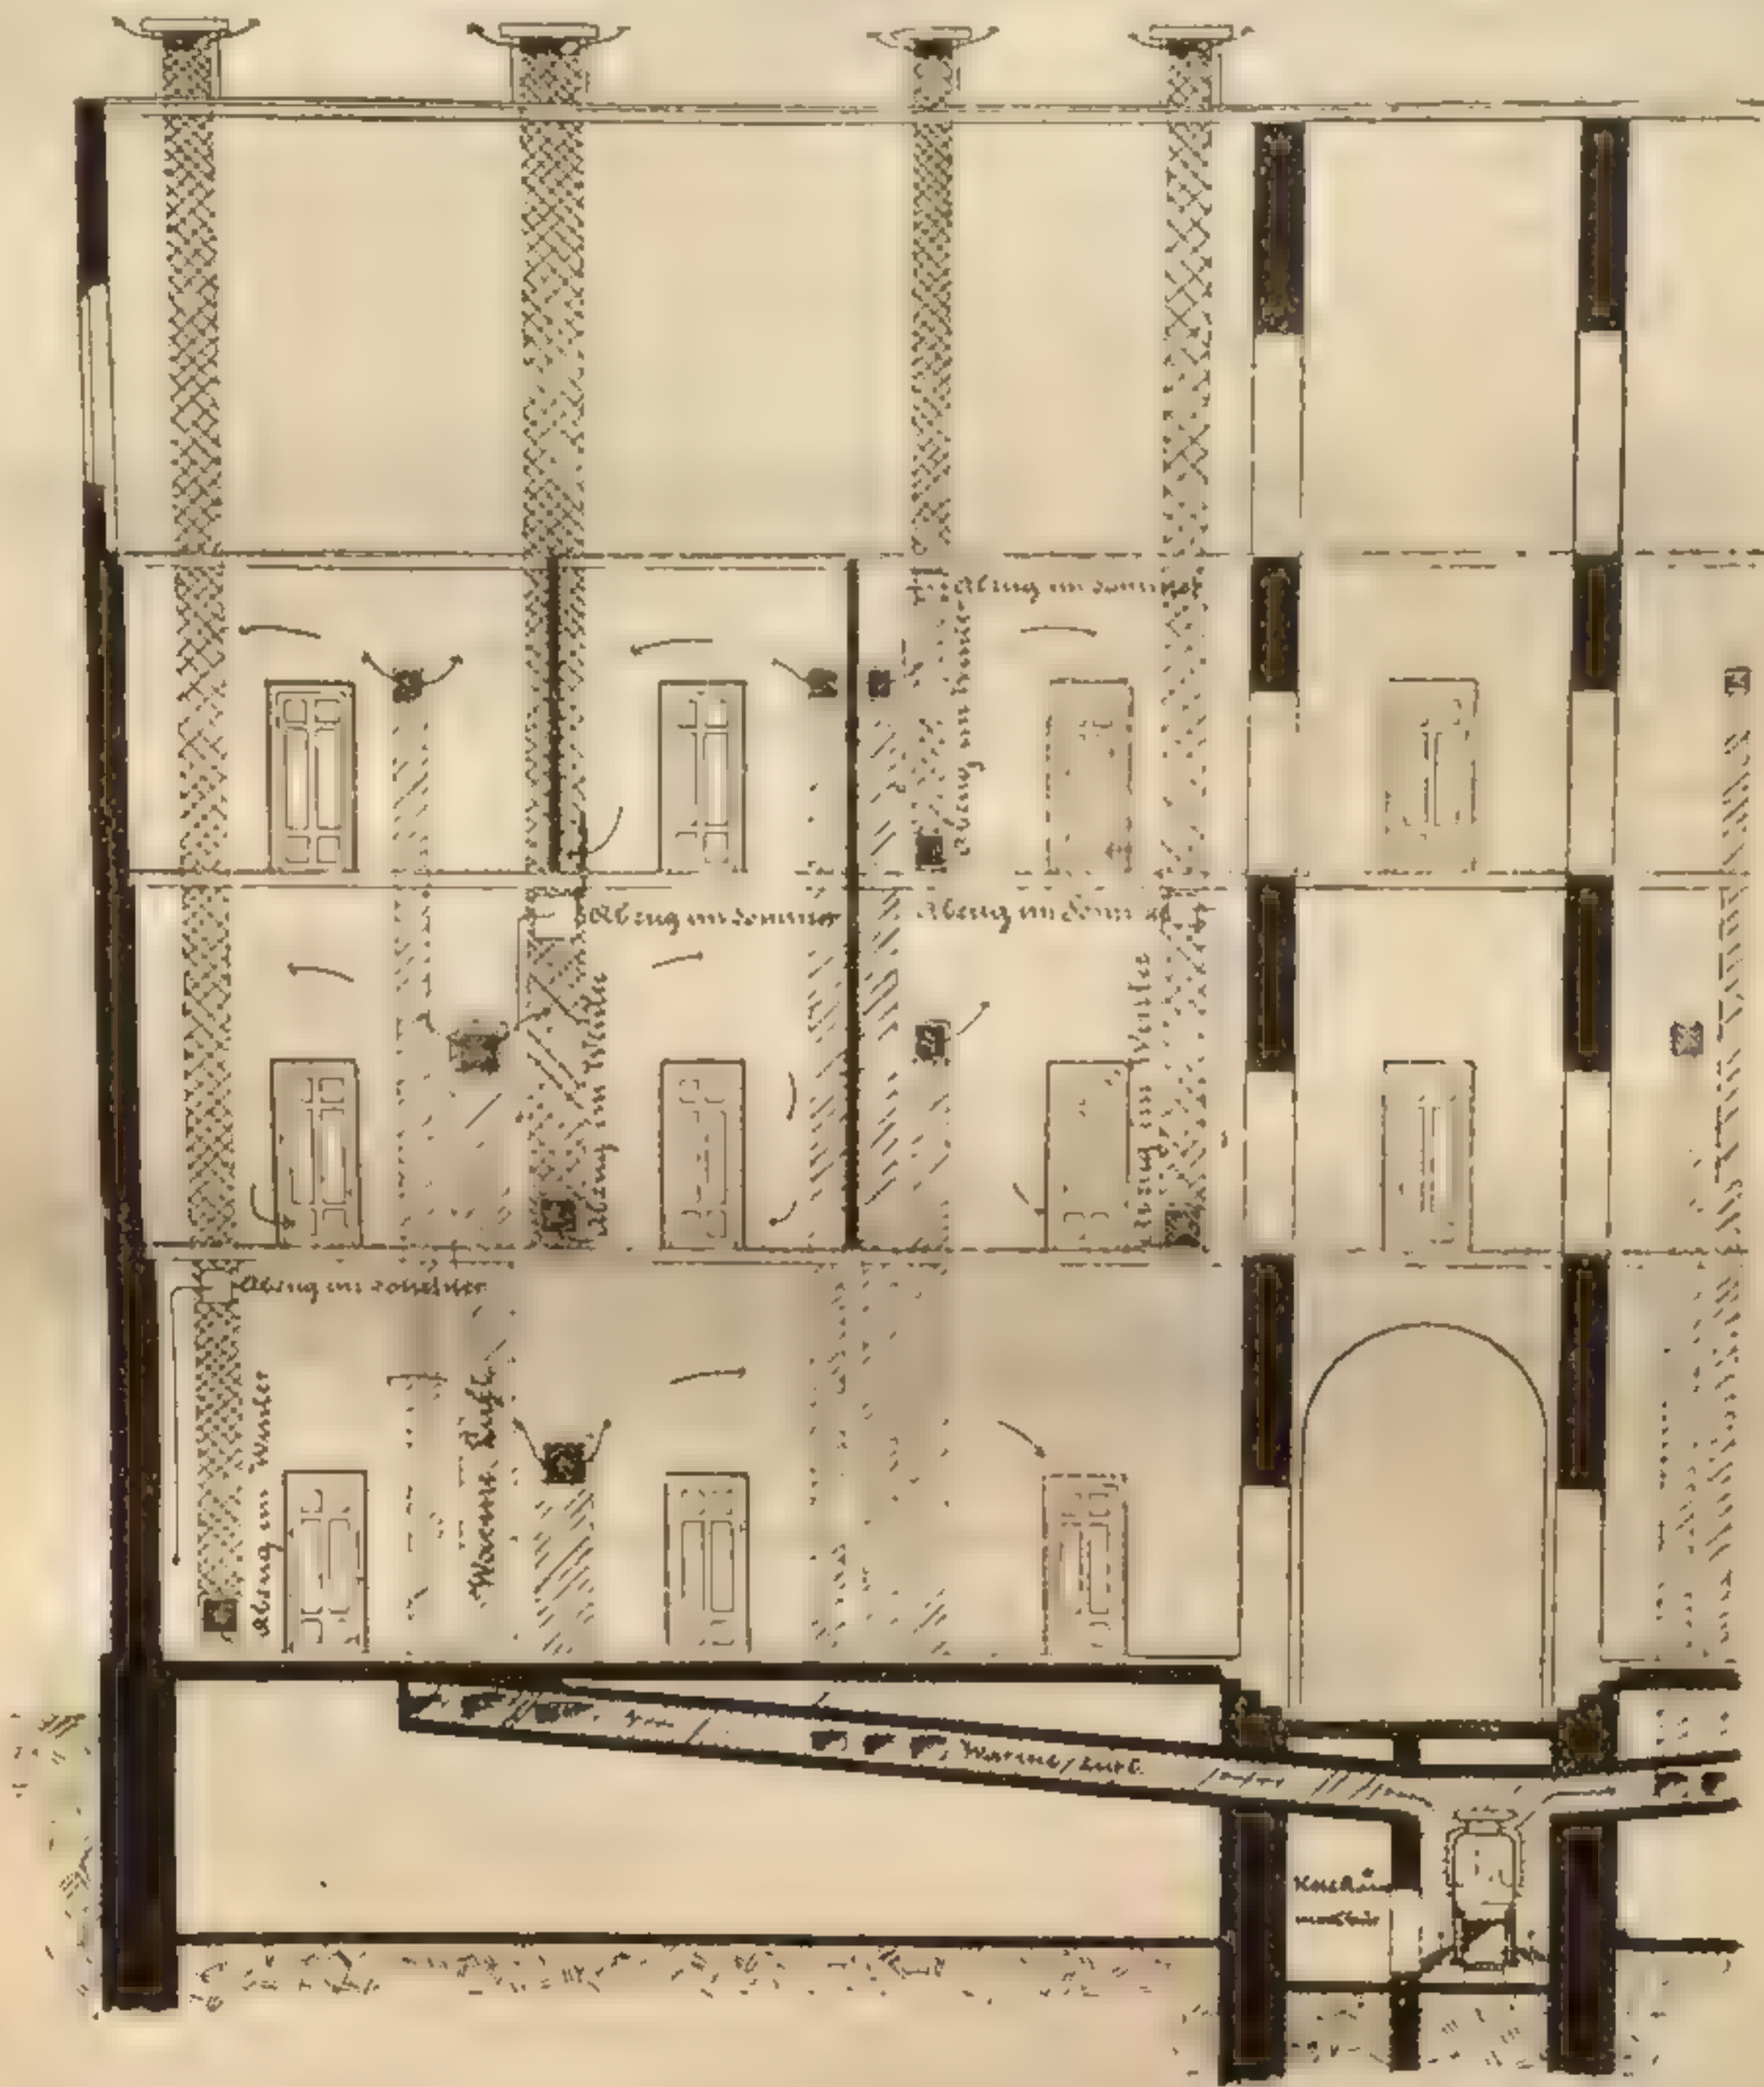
Продольный разрѣзъ черезъ подвальный этажъ, три жилыхъ этажа и чердакъ дома, снабженнаго центральнымъ воздушнымъ отопленіемъ. Каналы, приводящіе воздухъ, заштрихованы косыми линиями; каналы, отводящіе воздухъ—перекрестными линиями.
